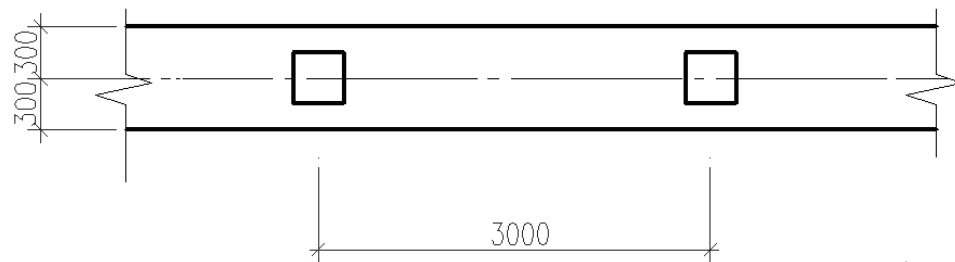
Схема расположения свай в рядовом фундаменте
